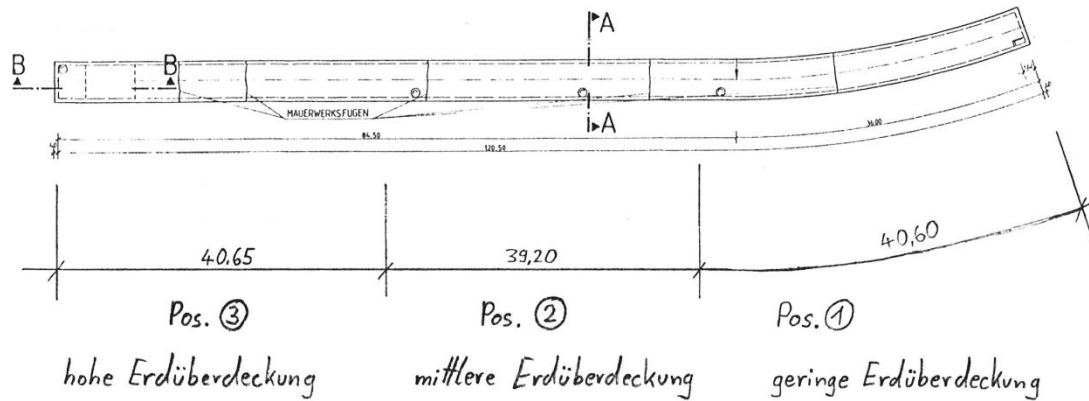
Grundriss-Skizze des Regenrückhaltebeckens
